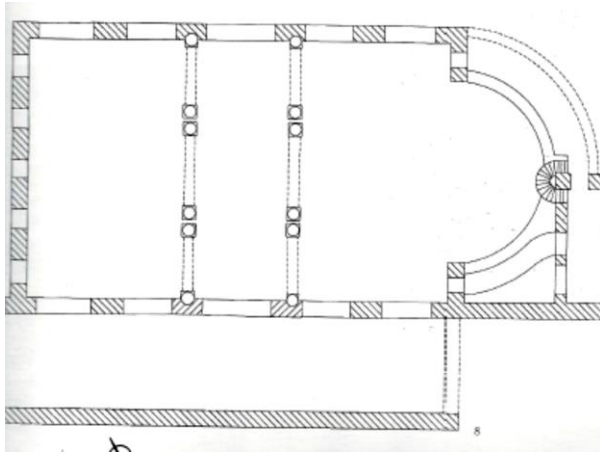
Abb. XLI: Grundriss von Santa Croce in Gerusalemme
